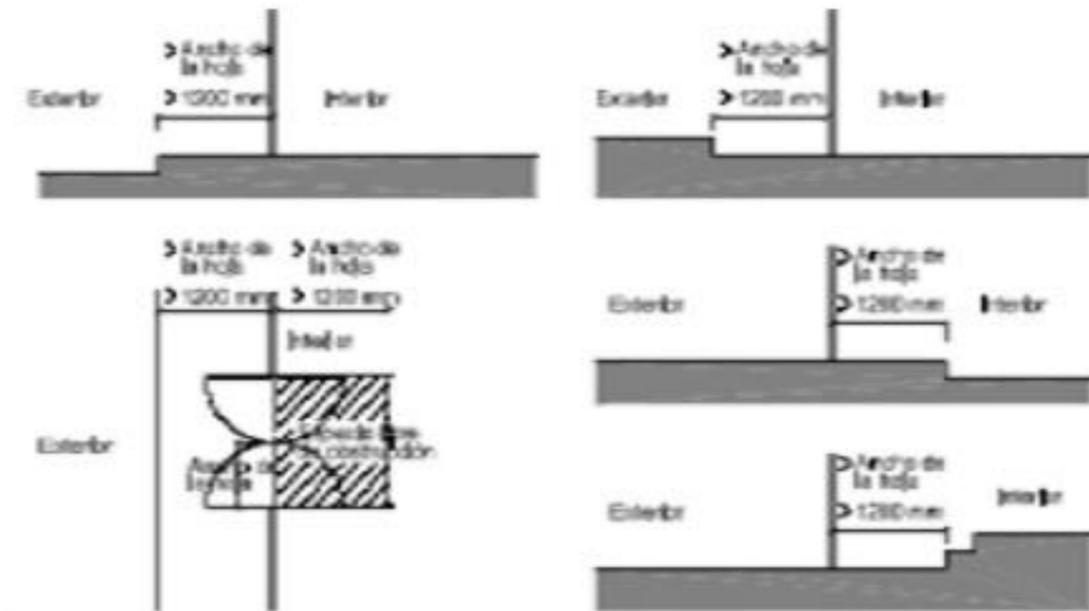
Distancia entre la puerta de acceso y el escalón más próximo.
